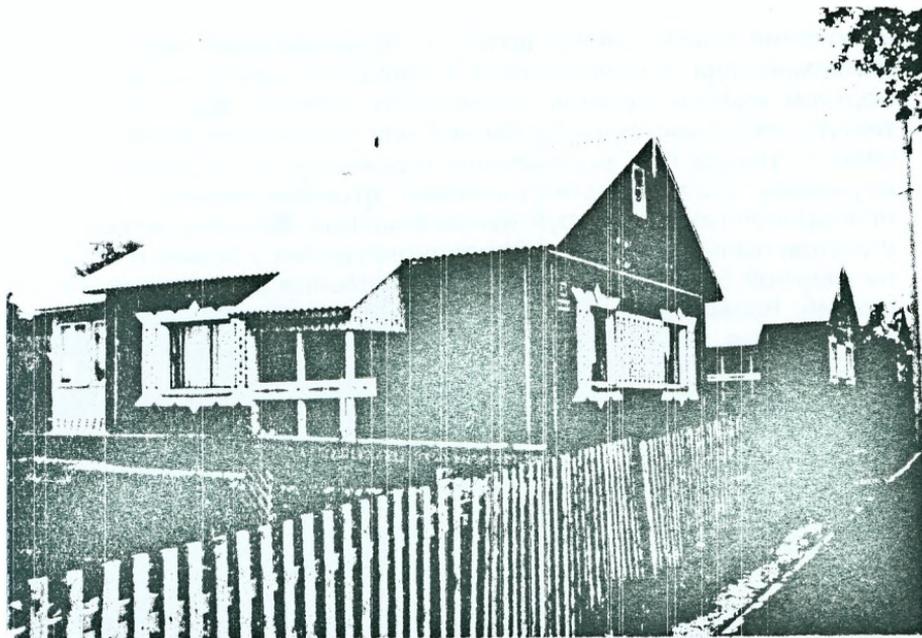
б. Одноквартирные жилые дома из керамзитобетона в населённом пункте Холмеч Речицкого района.
